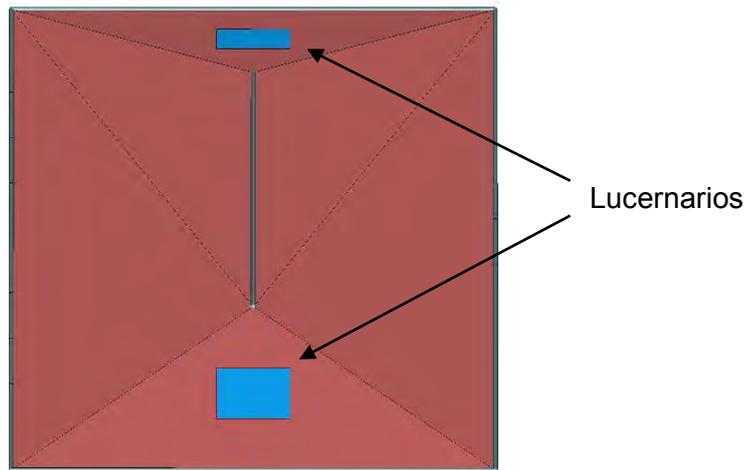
Imagen VII. Detalle de la simplificación de la planta cubierta (Fuente: HULC)
